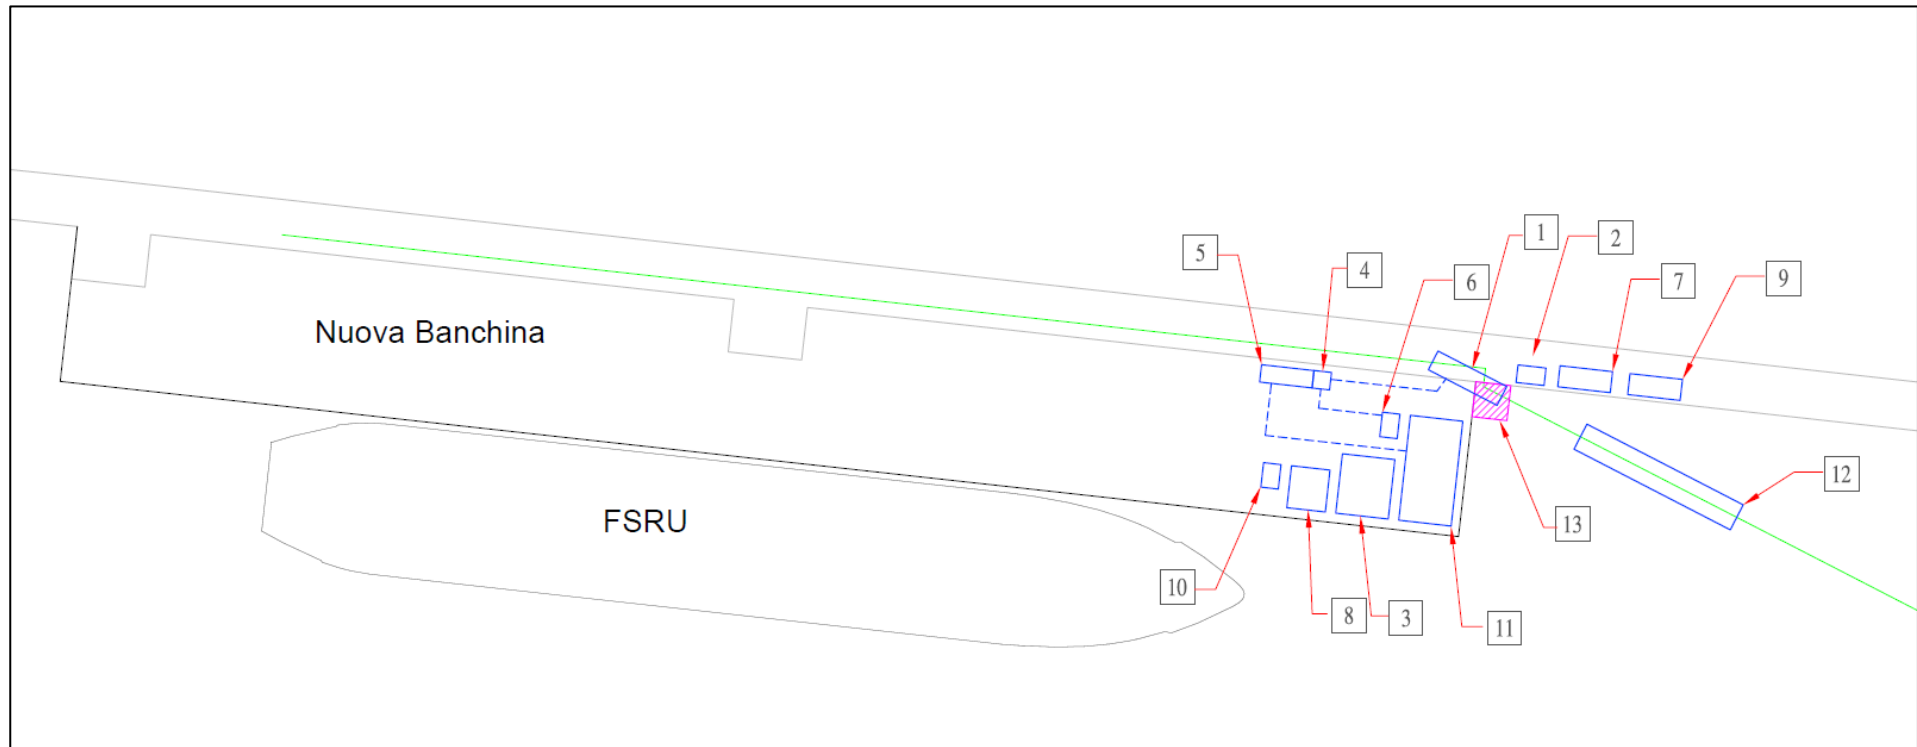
Disposizione preliminare del cantiere TOC lato diga foranea
